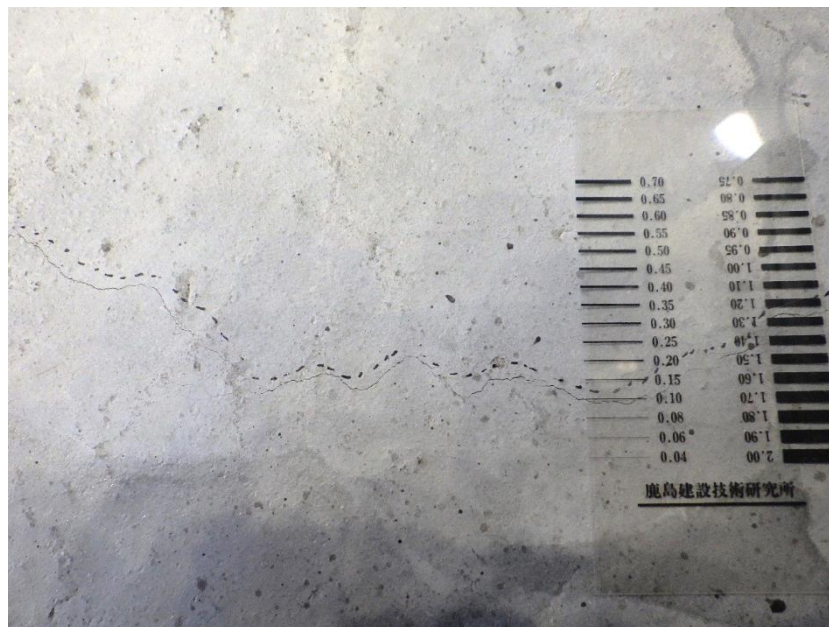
ひび割れ発生状況（0.1mm 程度）
